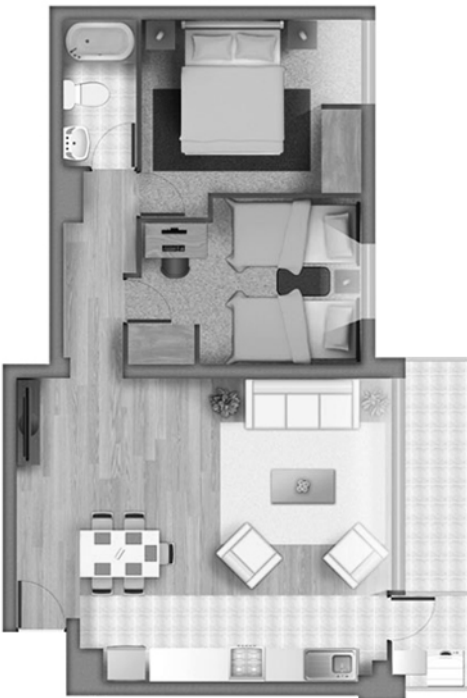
Planta vivienda 3D-2B en condominio ALC.
